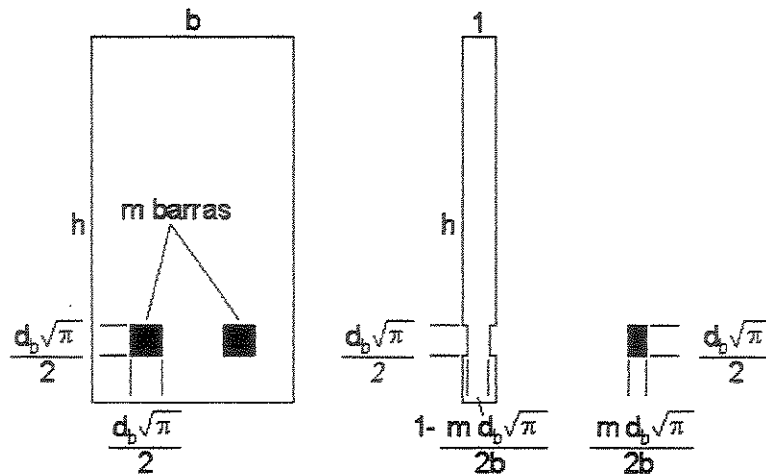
Seção modificada (unitária) de um elemento de concreto armado.
